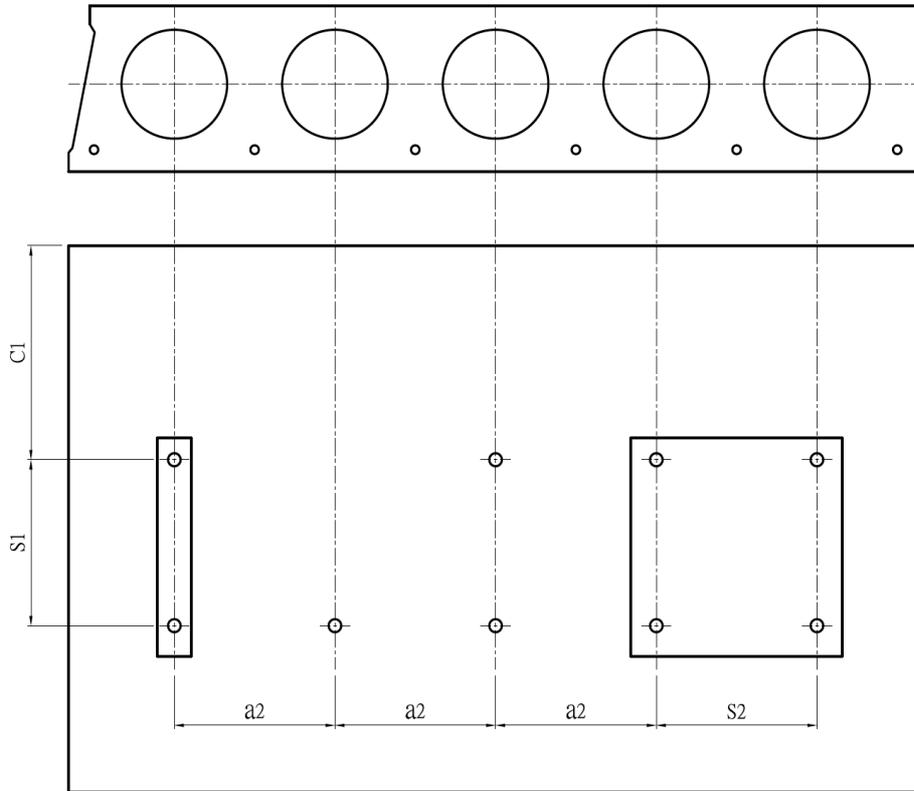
Parámetros de instalación para anclajes en losas alveolares de hormigón.
